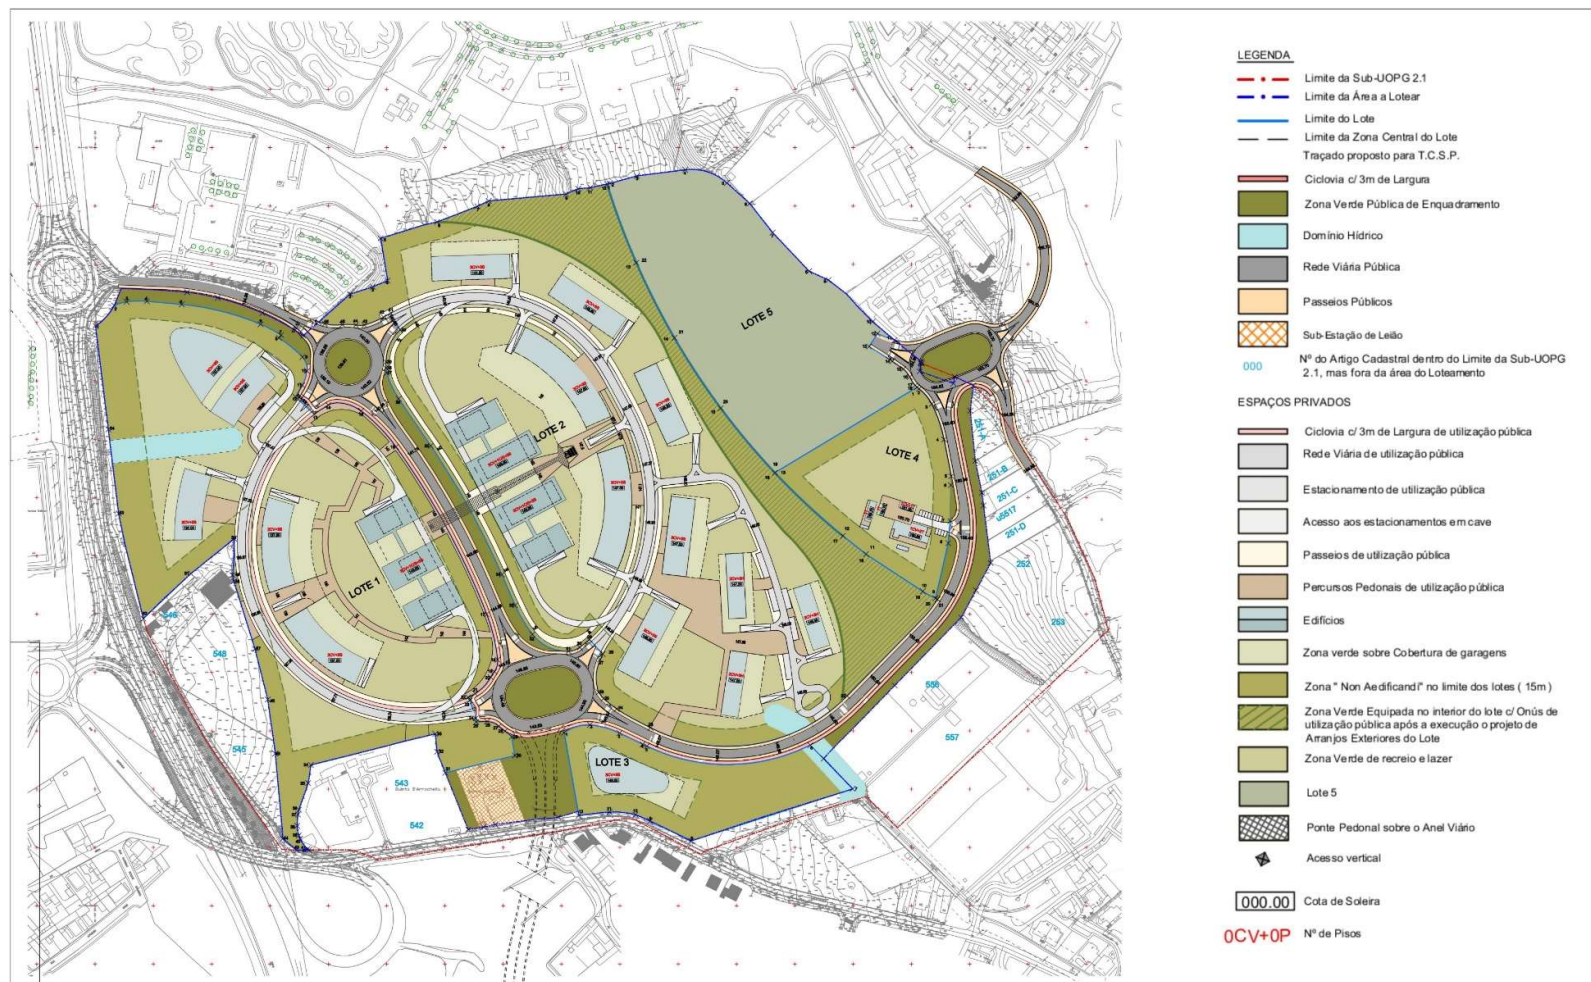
Planta Síntese da proposta de base. Fonte: JQPV, 2021
